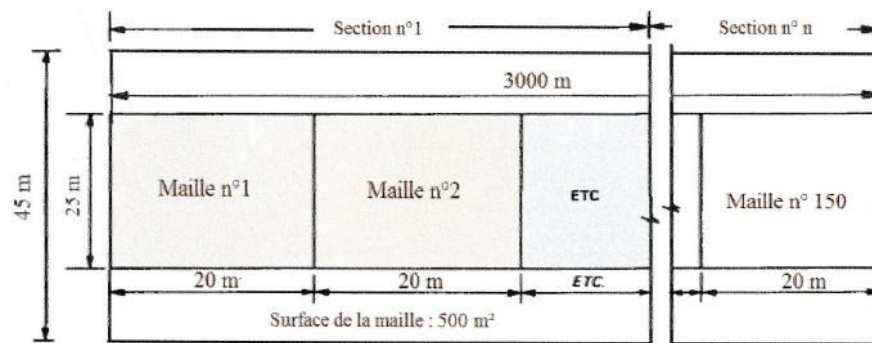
6.3 Exemple de maillage sur chaussée souples
